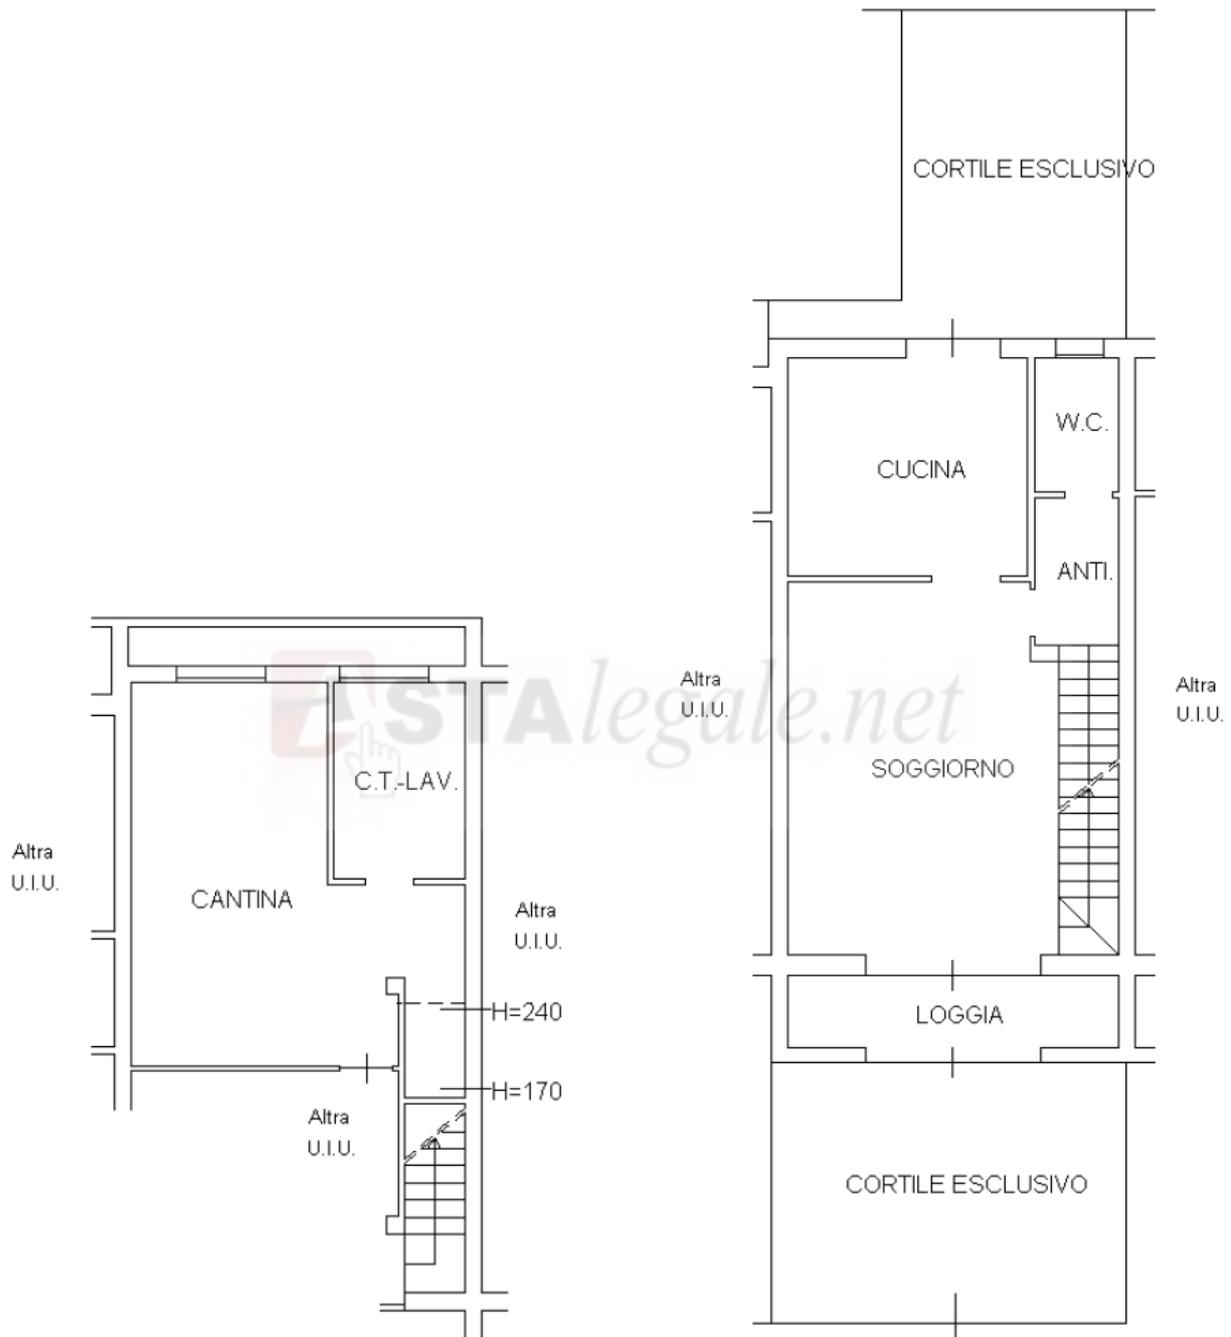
Estratto della planimetria catastale – sub. 6, p.int. e p.t.
